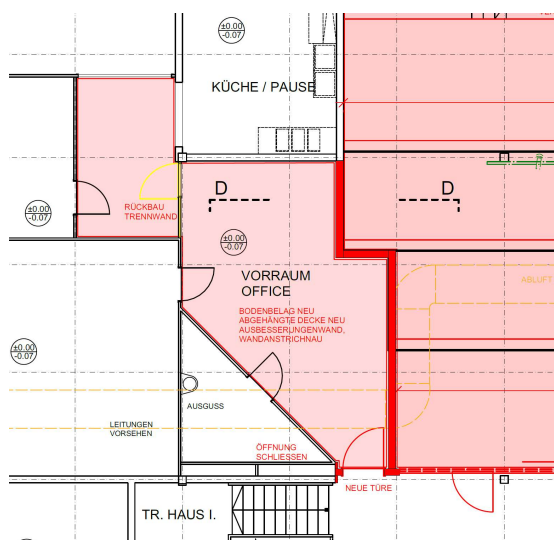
, Planausschnitt: Grundriss Vorraum Office
